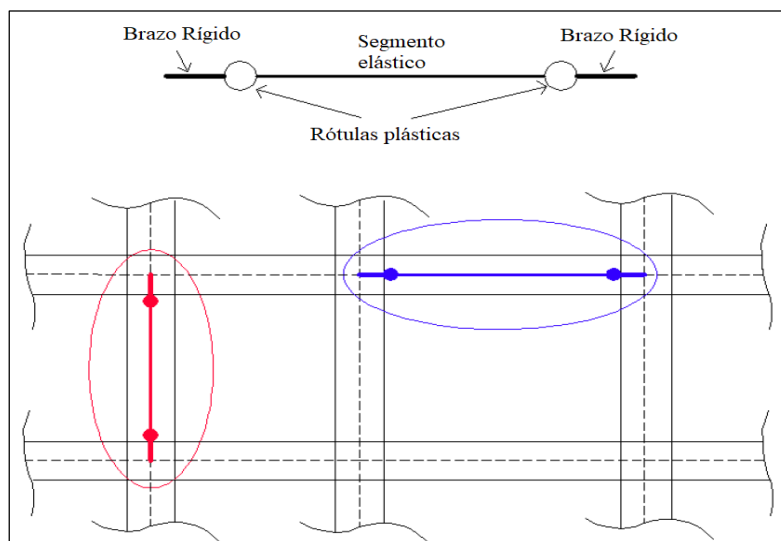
Modelado de rótulas y columnas en edificios (Fuente: Fernández y Navarro, 2006)
